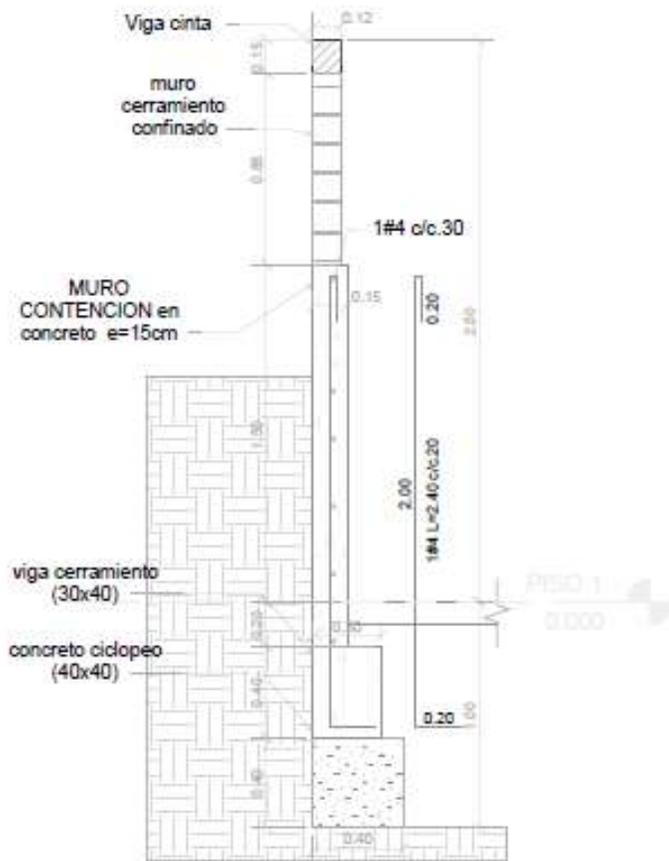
ARMADO DE MURO DE CONTENCIÓN.
